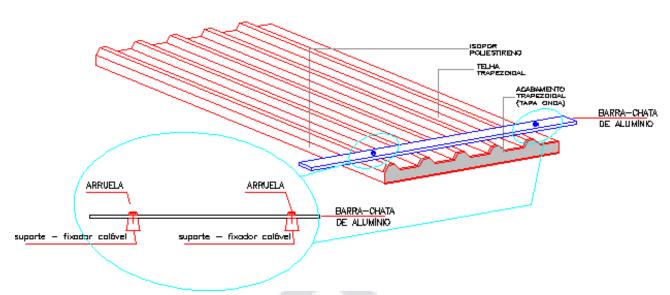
Fixação da Barra de Alumínio em Telha isotérmica
